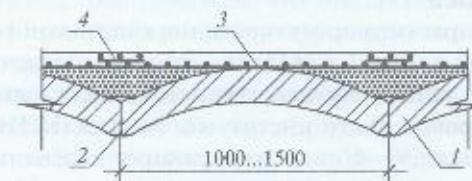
Усиление каменных перекрытий наращиванием железобетонной плиты сверху:
